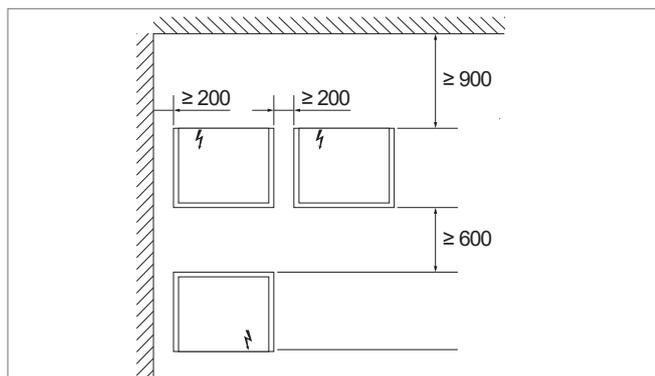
Espace nécessaire pour le groupe de condensation (dimensions en mm)
